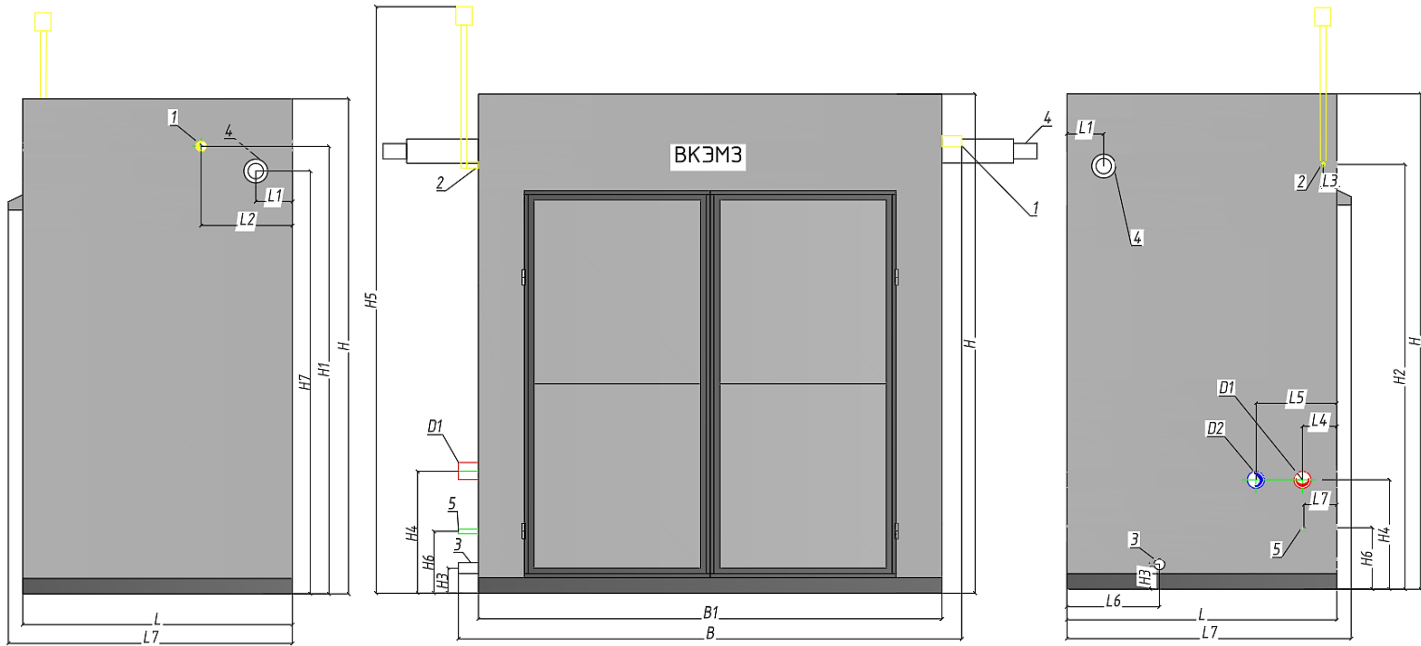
Габаритно-присоединительные размеры котла наружного размещения
